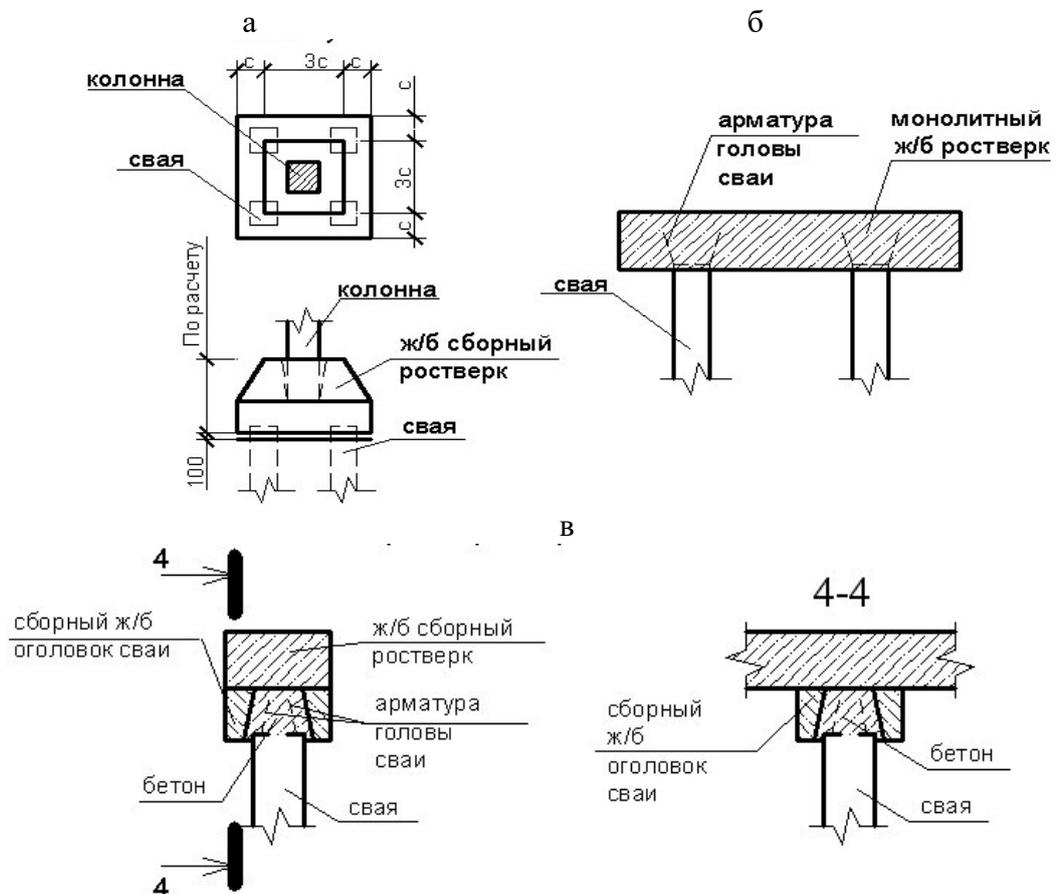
Рostверки под свай: а – куст свай под колонну, б- монолитный, в - сборный
